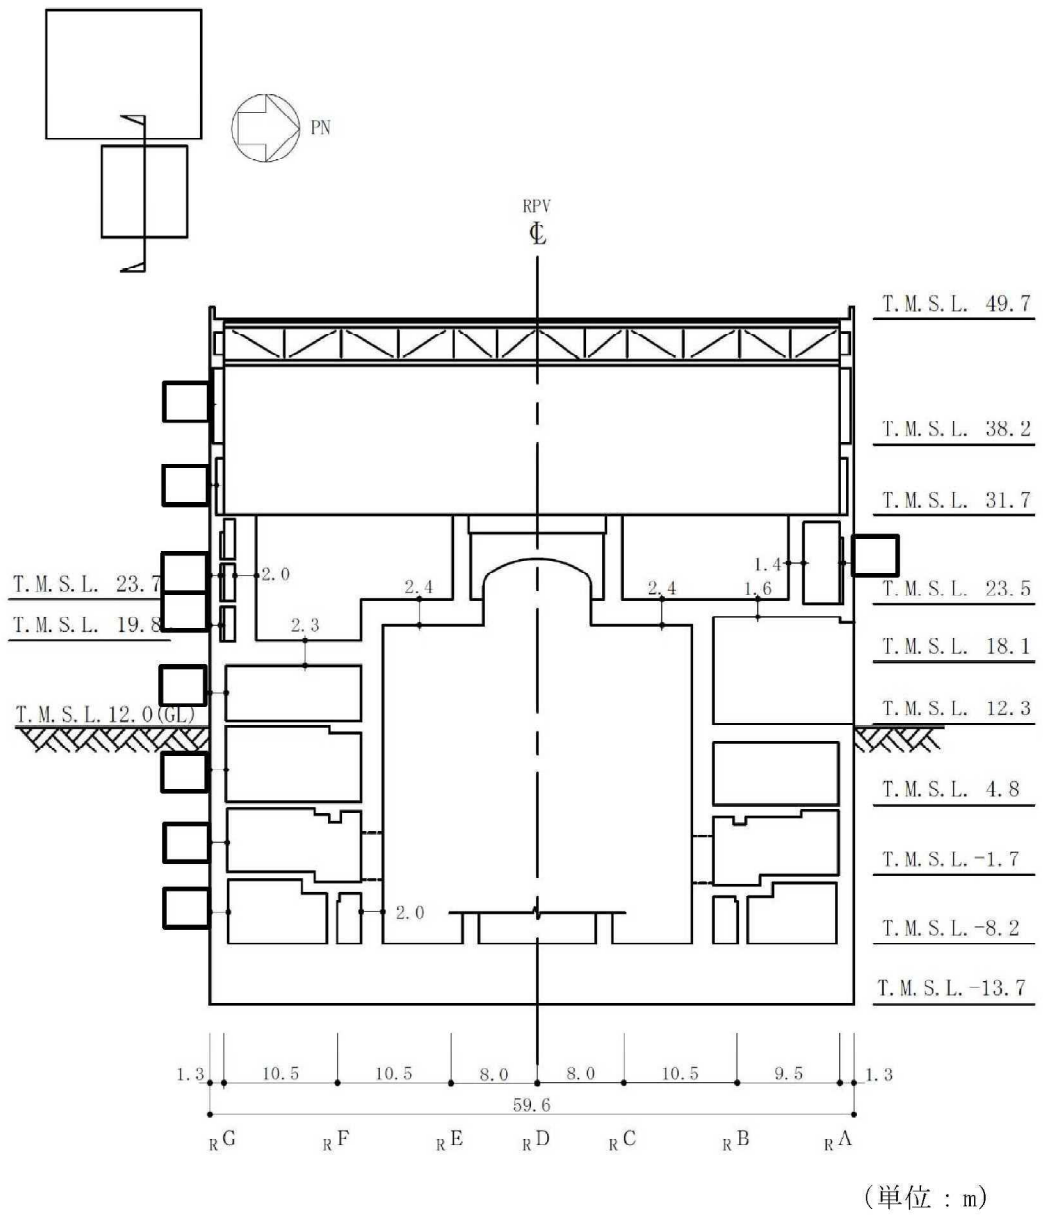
原子炉建屋の概略断面図 (EW 方向) (2/2)
